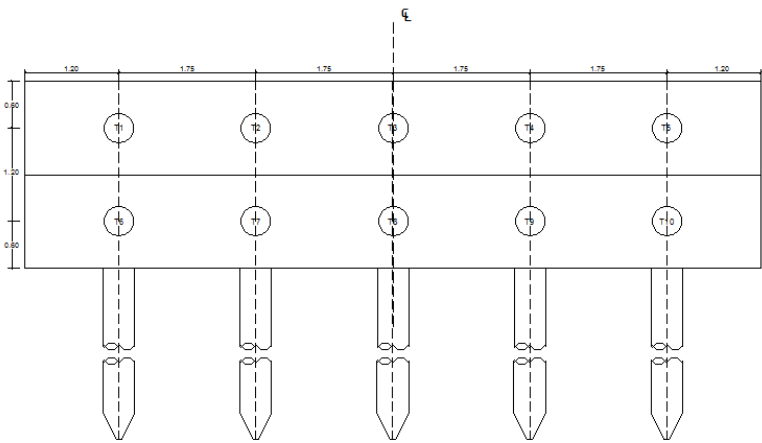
Beban pada Pile Cap Abutment (Abt 1 )
